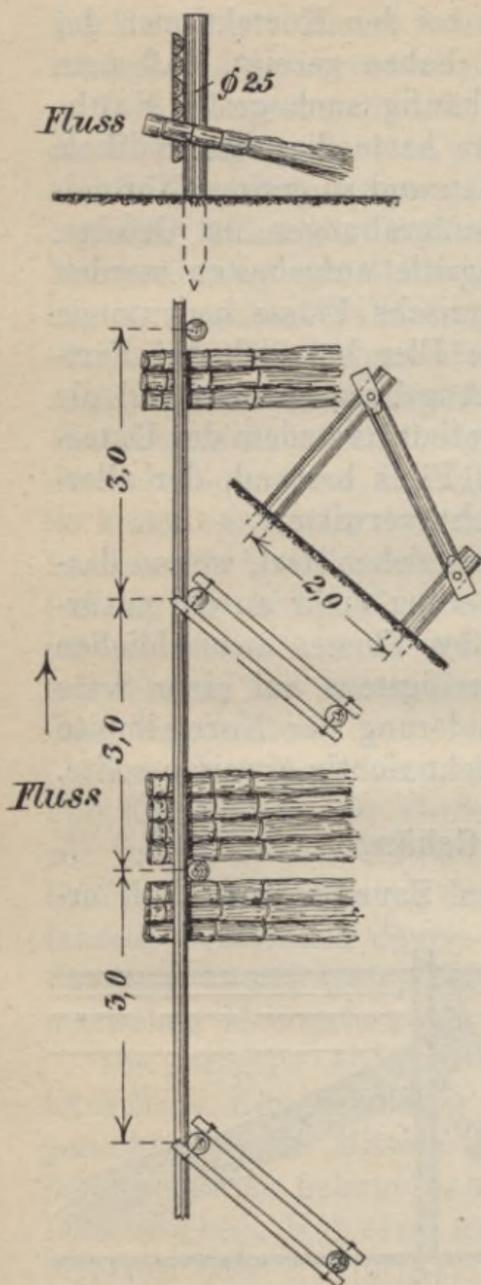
Wolfsche Gehänge in der Ill bei Schruns.
